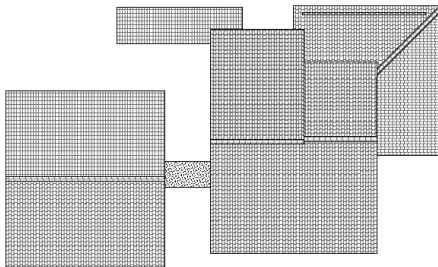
Planta Cubierta. Fuente propia. Archicad 20. 2018
